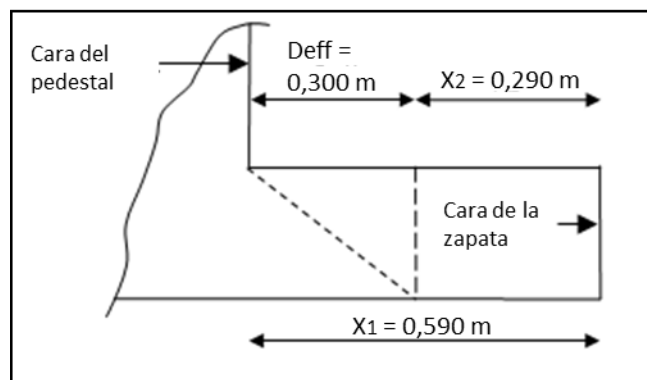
Corte representativo de la fundación. Fuente: STAAD Foundation Advanced.
